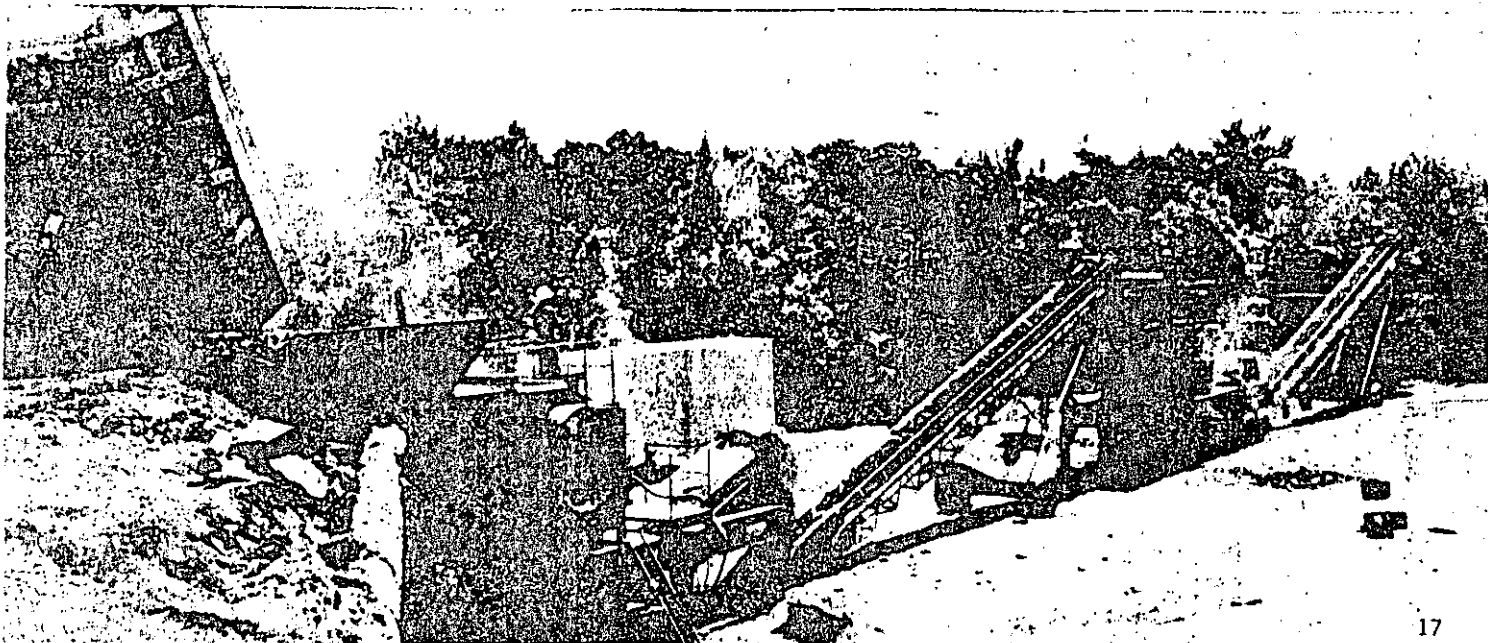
Planta portátil de trituración y cribado por vía seca, mostrándose la descarga de roca del camión a la tolva de recepción del grupo primario y las bandas transportadoras portátiles de conexión del grupo primario al secundario, y del grupo secundario al terciario.
